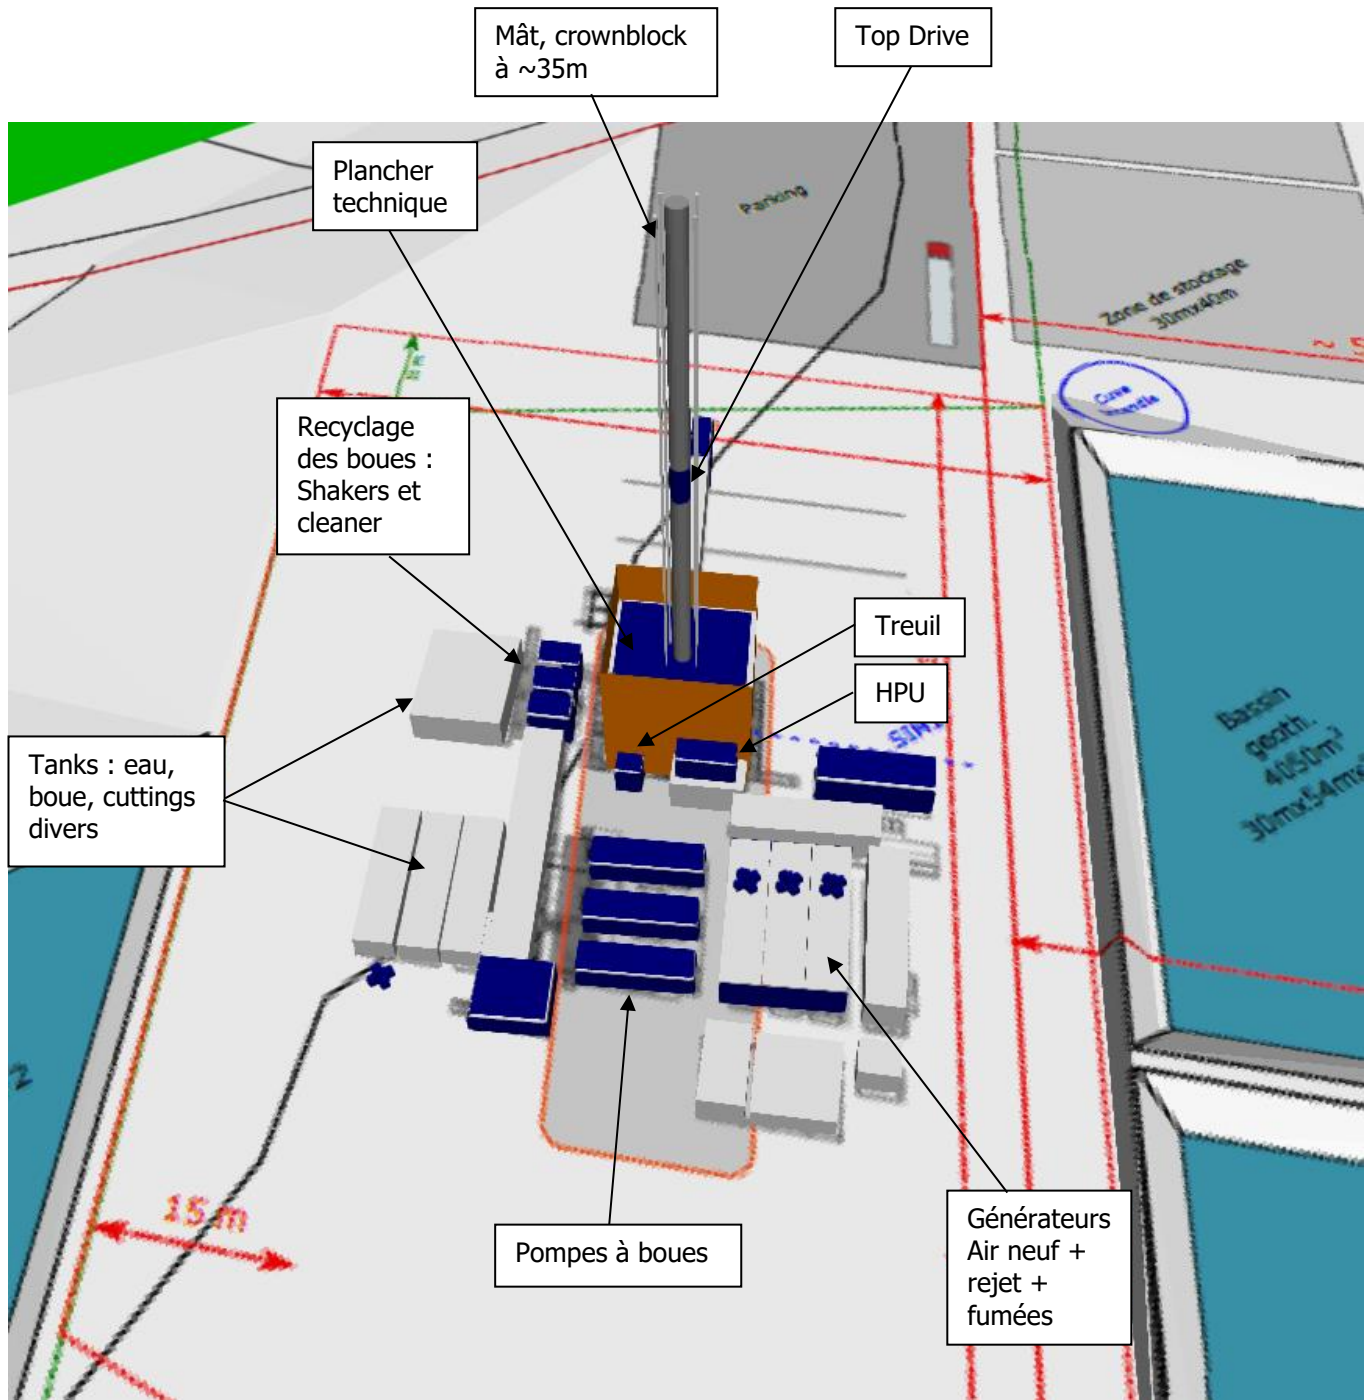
élévation des bâtiment sur plan de masse du rig – modélisation géométrique
